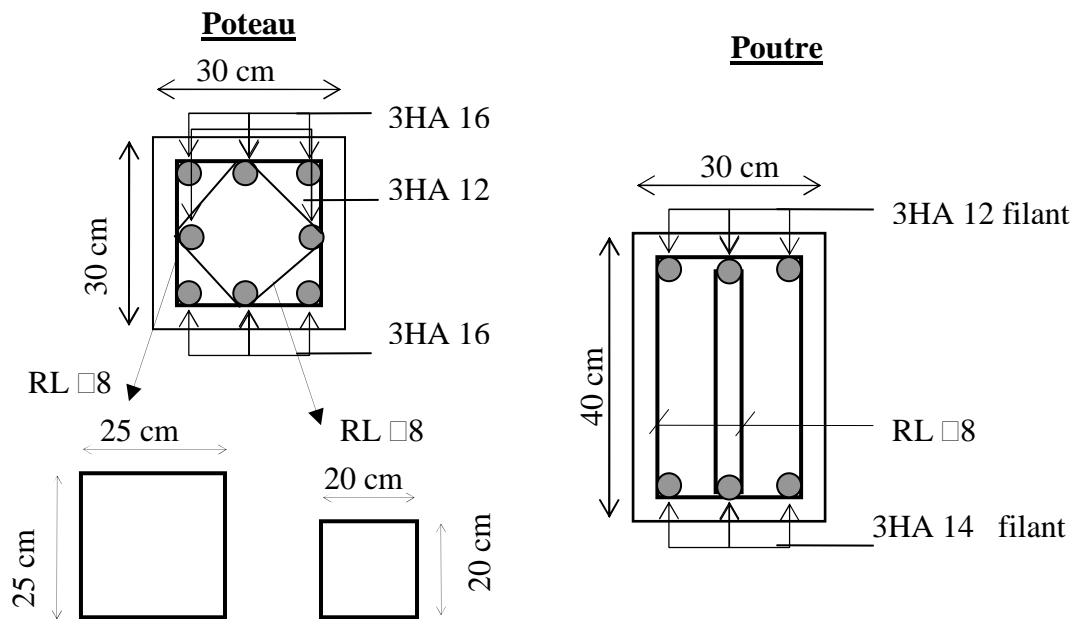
Sections et ferrailage des poteaux et poutres
